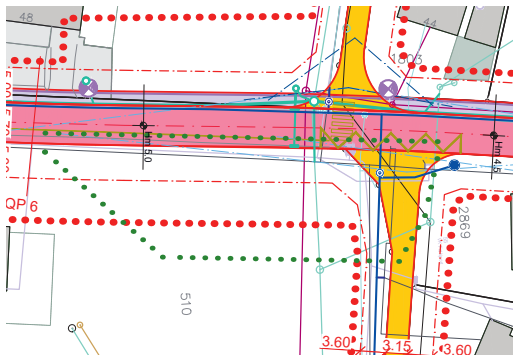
Ausschnitt Überbauungsplan Änderung - Alter Zustand
